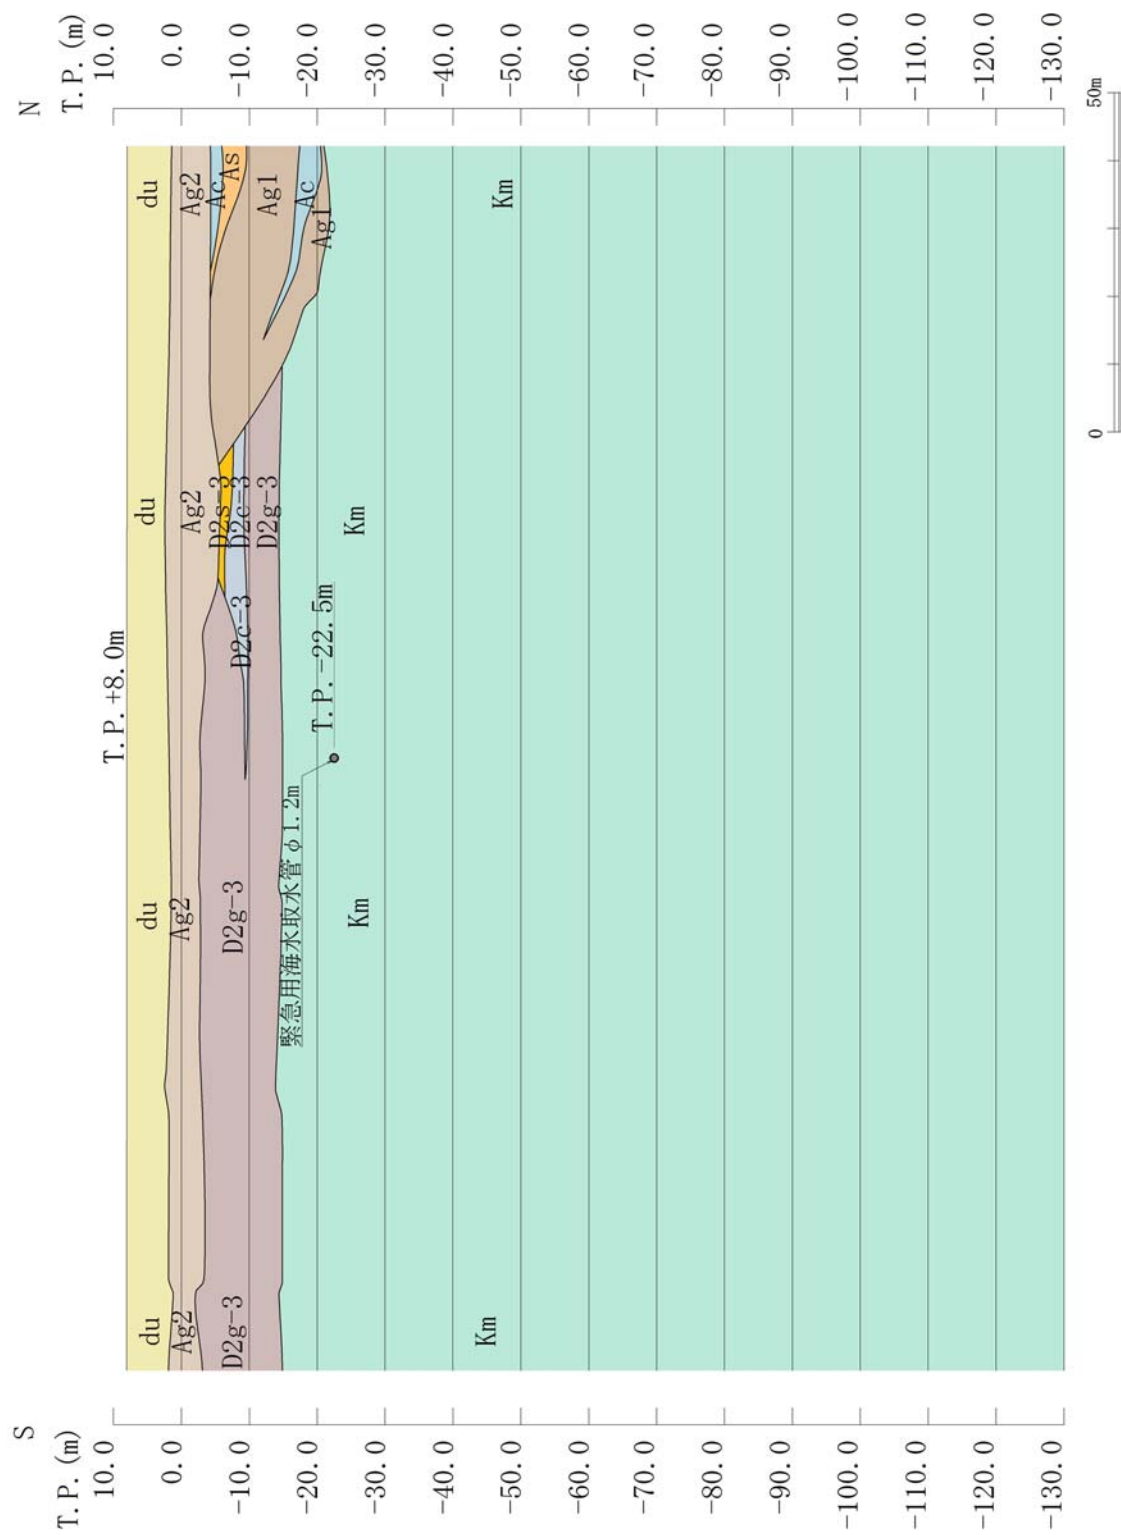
緊急用海水取水管 横断面図 (②-②断面)
